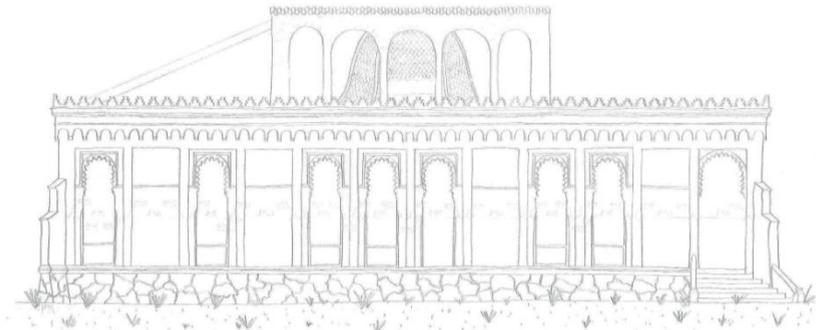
Croquis Alzado Este (2014) - Fuente propia
